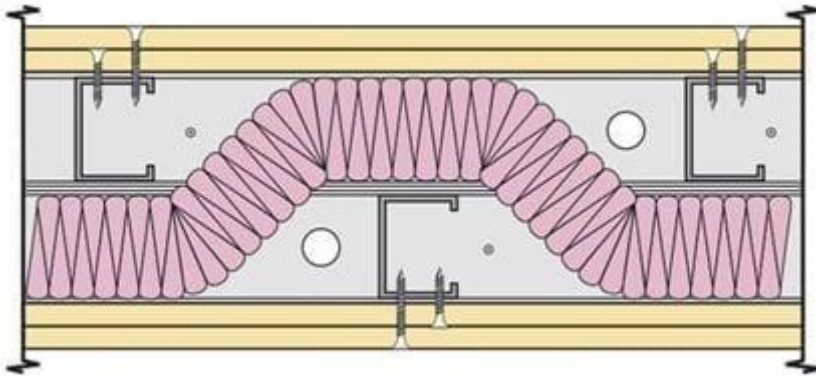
modelo de parede dupla com drywall e lã fonoabsorvente.
